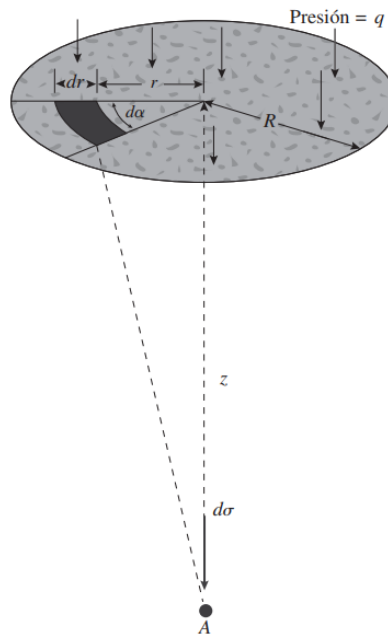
Incremento en la presión bajo de un área circular flexible cargada uniformemente
